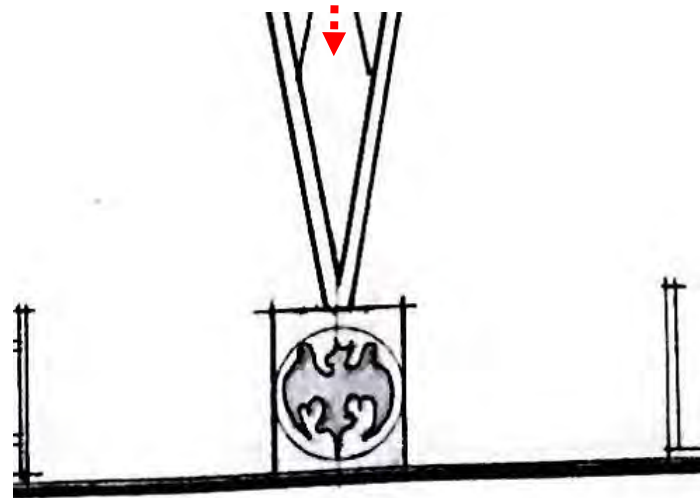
Variante de Estructura de acceso conjunto Bacardí Detalle
